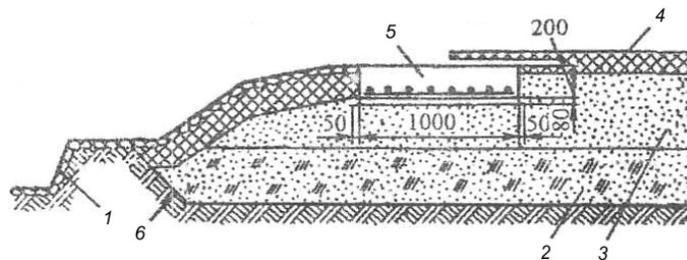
Конструкция основания и фундаментов под вертикальные стальные резервуары:
